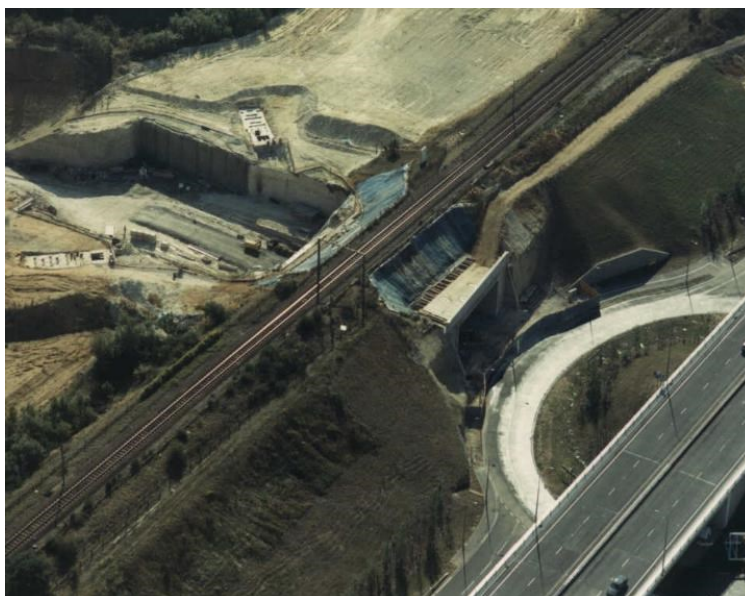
Tunel pro silniční dopravu, West Thurrock - při protlačování
